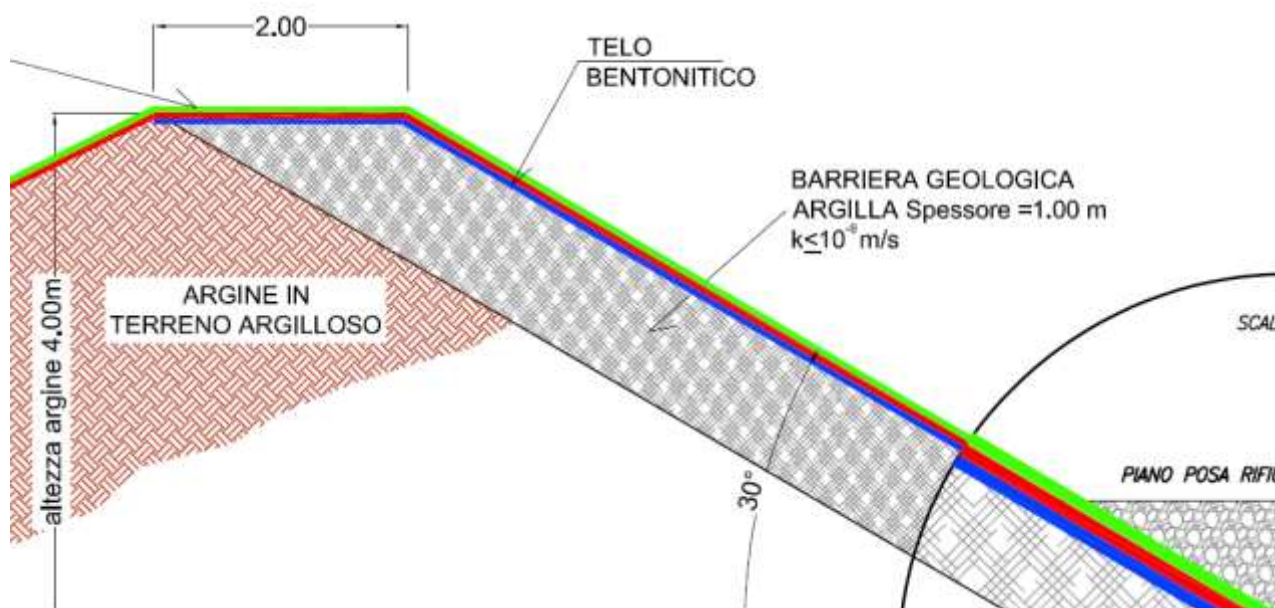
Particolare del pacchetto di impermeabilizzazione del fondo discarica- Estratto della Tavola 14
